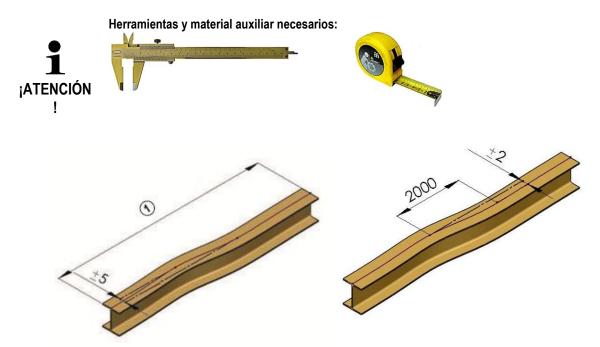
Variación dimensional horizontal al soporte del perfil de rodadura
